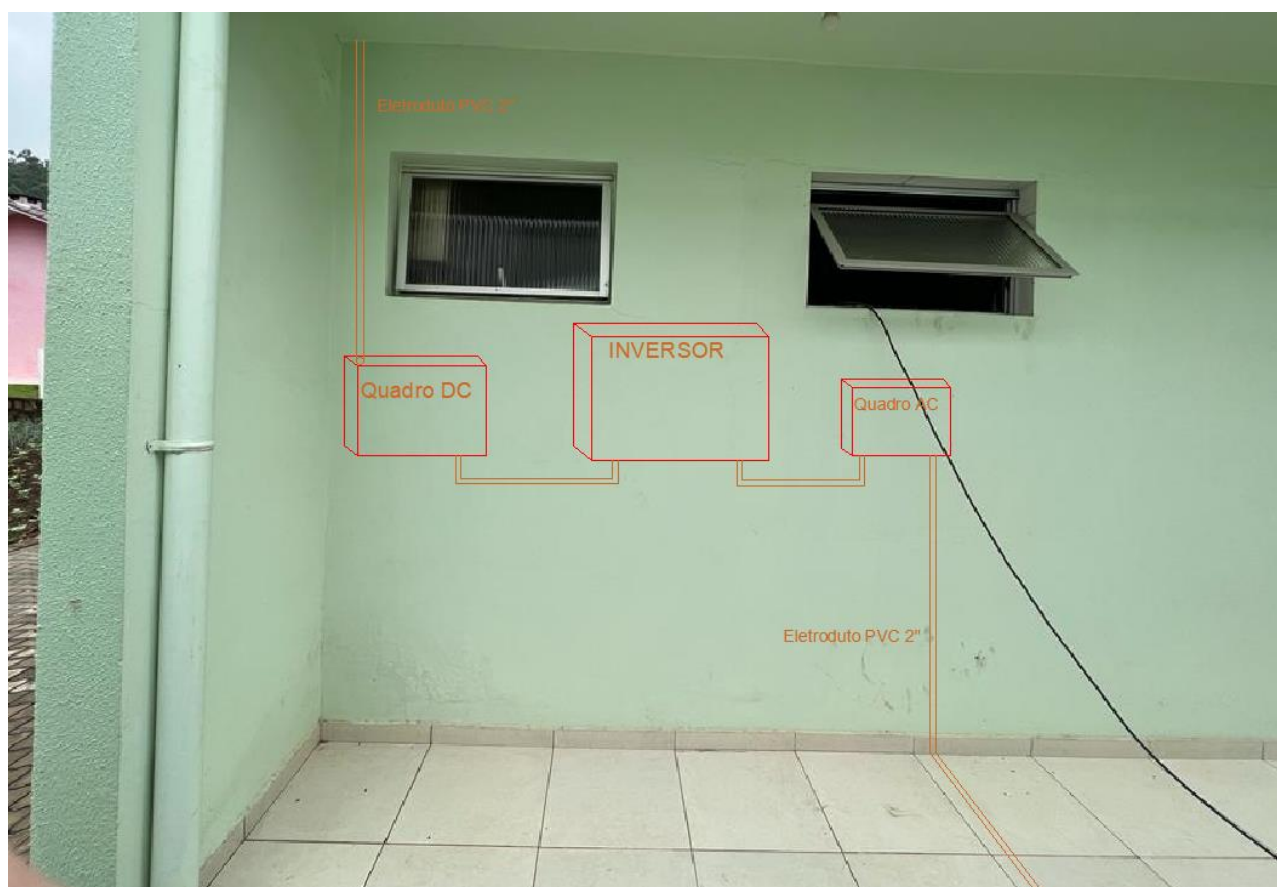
Local de Instalação do inversor e caixa de proteção CC e CA.
